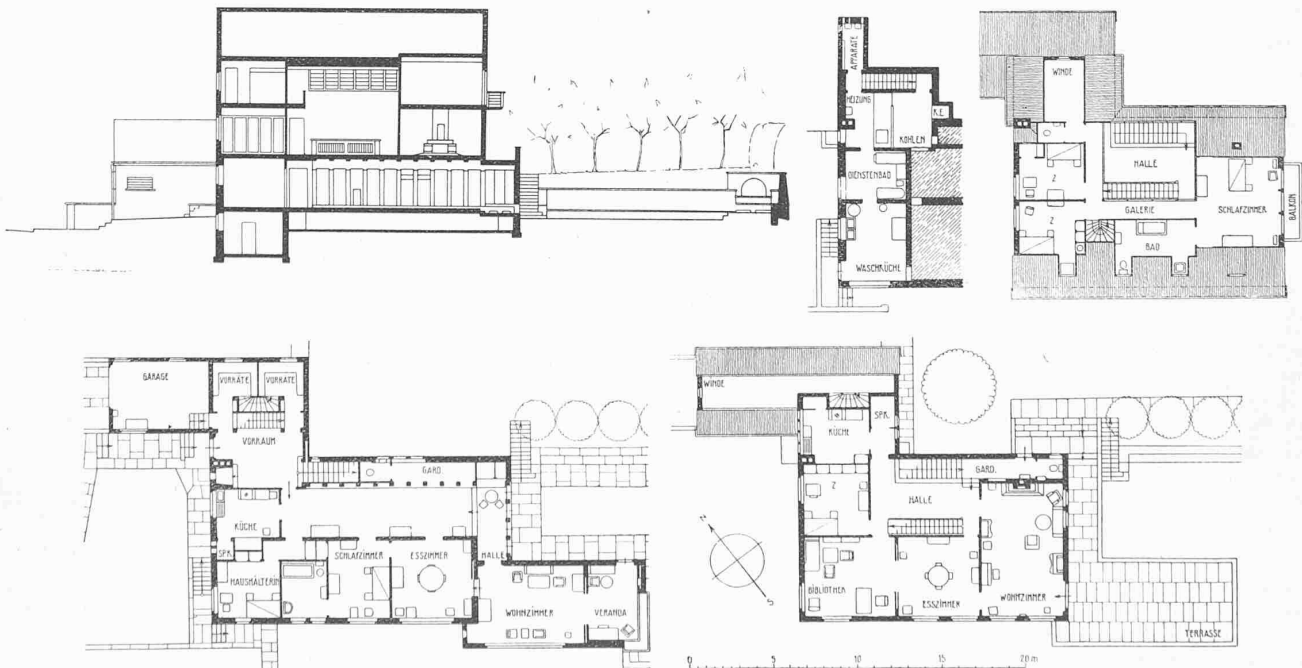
und 3. Grundriss vom Erdgeschoss und Längsschnitt. — Masstab 1: 400. — Abb. 4 bis 6. Grundrisse vom Keller, Obergeschoss und Dachstock.
